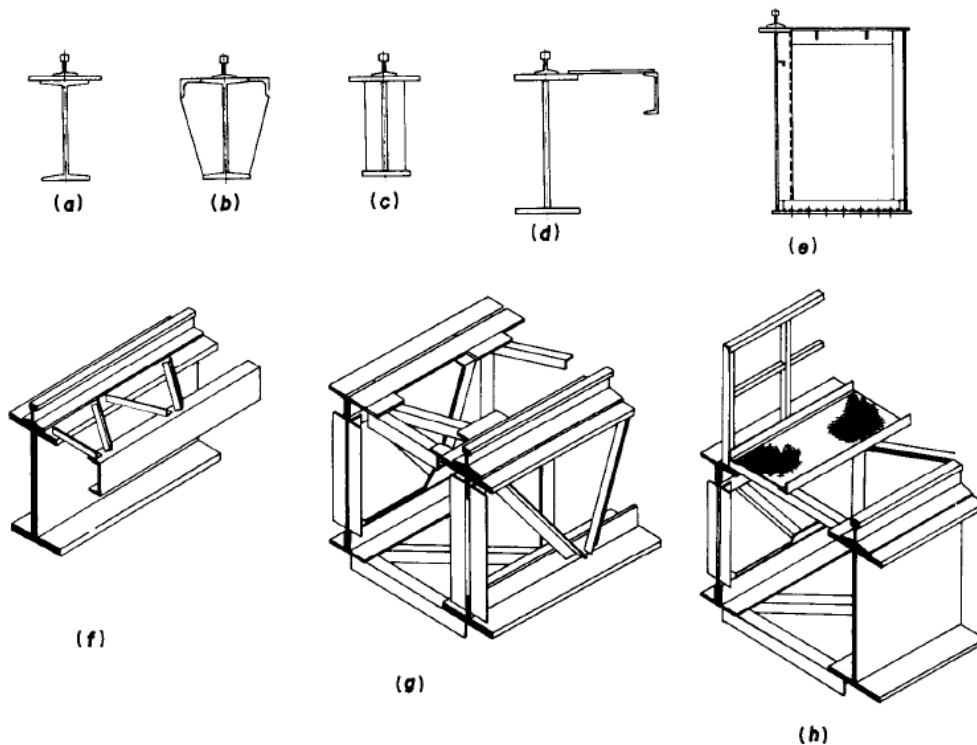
Tipos de seção utilizadas em vigas de rolamento.
